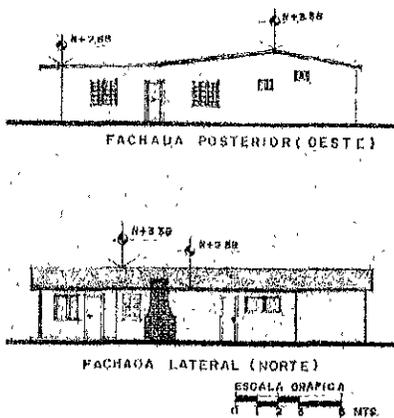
Fachadas posterior (Oeste) y lateral (Norte), casa 11.
